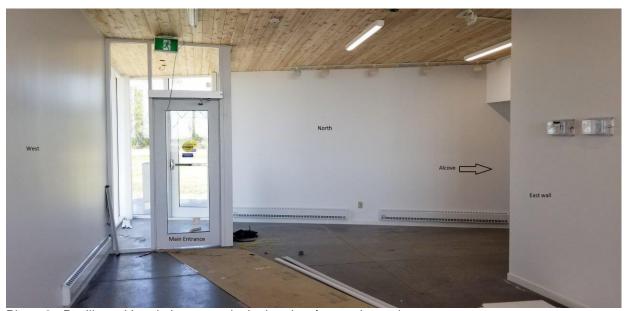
Pavillon – Vue de la porte principale orientée vers le nord
